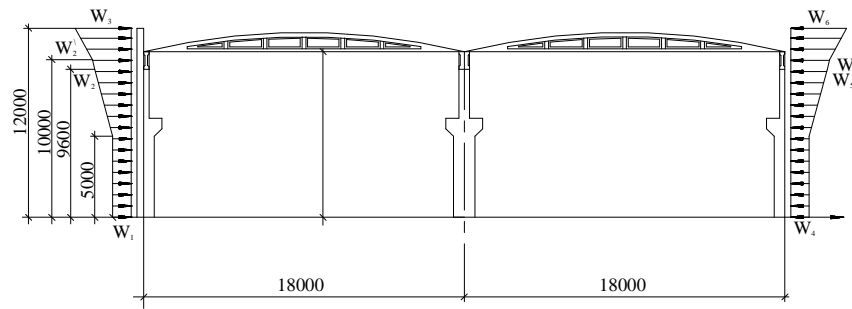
Схема до розрахунку поперечної рами на вітрове навантаження
